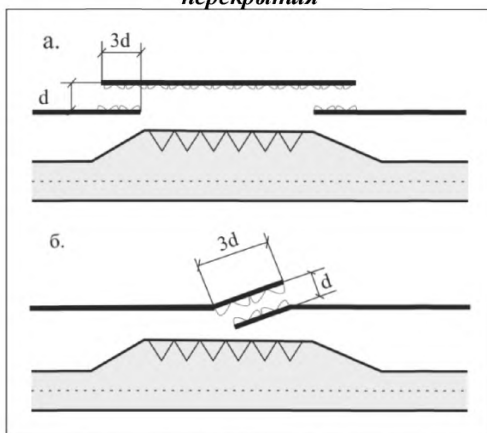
Схемы устройства экранов на участках разрыва и перекрытия
